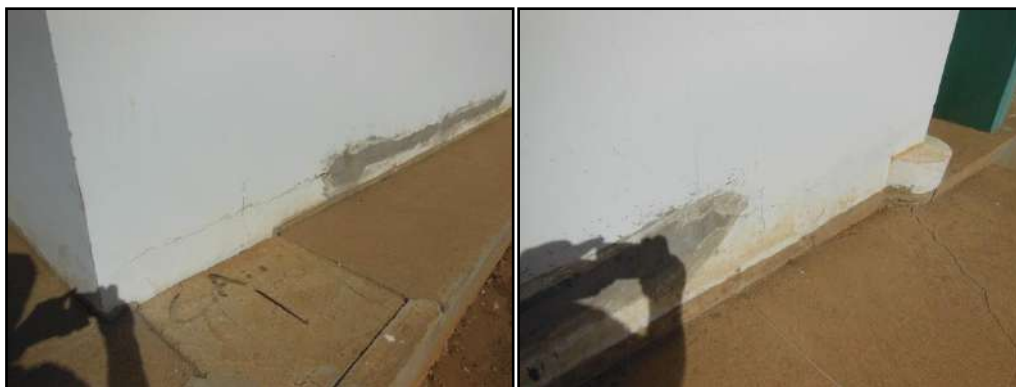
trinca na fachada acima da viga baldrame.
